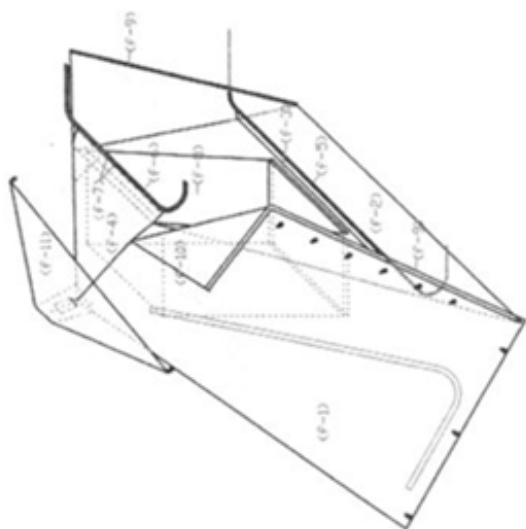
ASSONOMETRIA STRUTTURA TELESCOPICA
